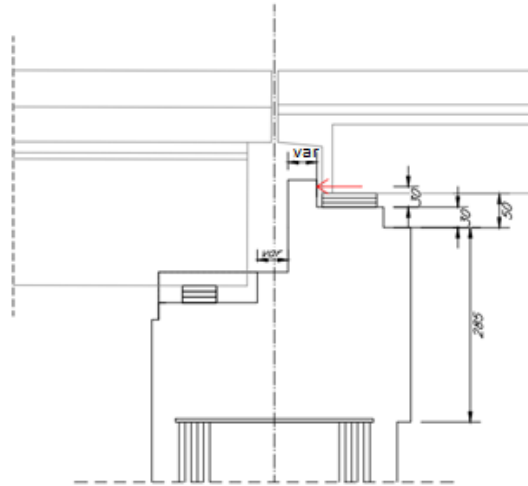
Schema di applicazione delle forze sul ritegno sismico longitudinale con appoggi fissi lato impalcato a Travi Incorporate (Prospetto)
